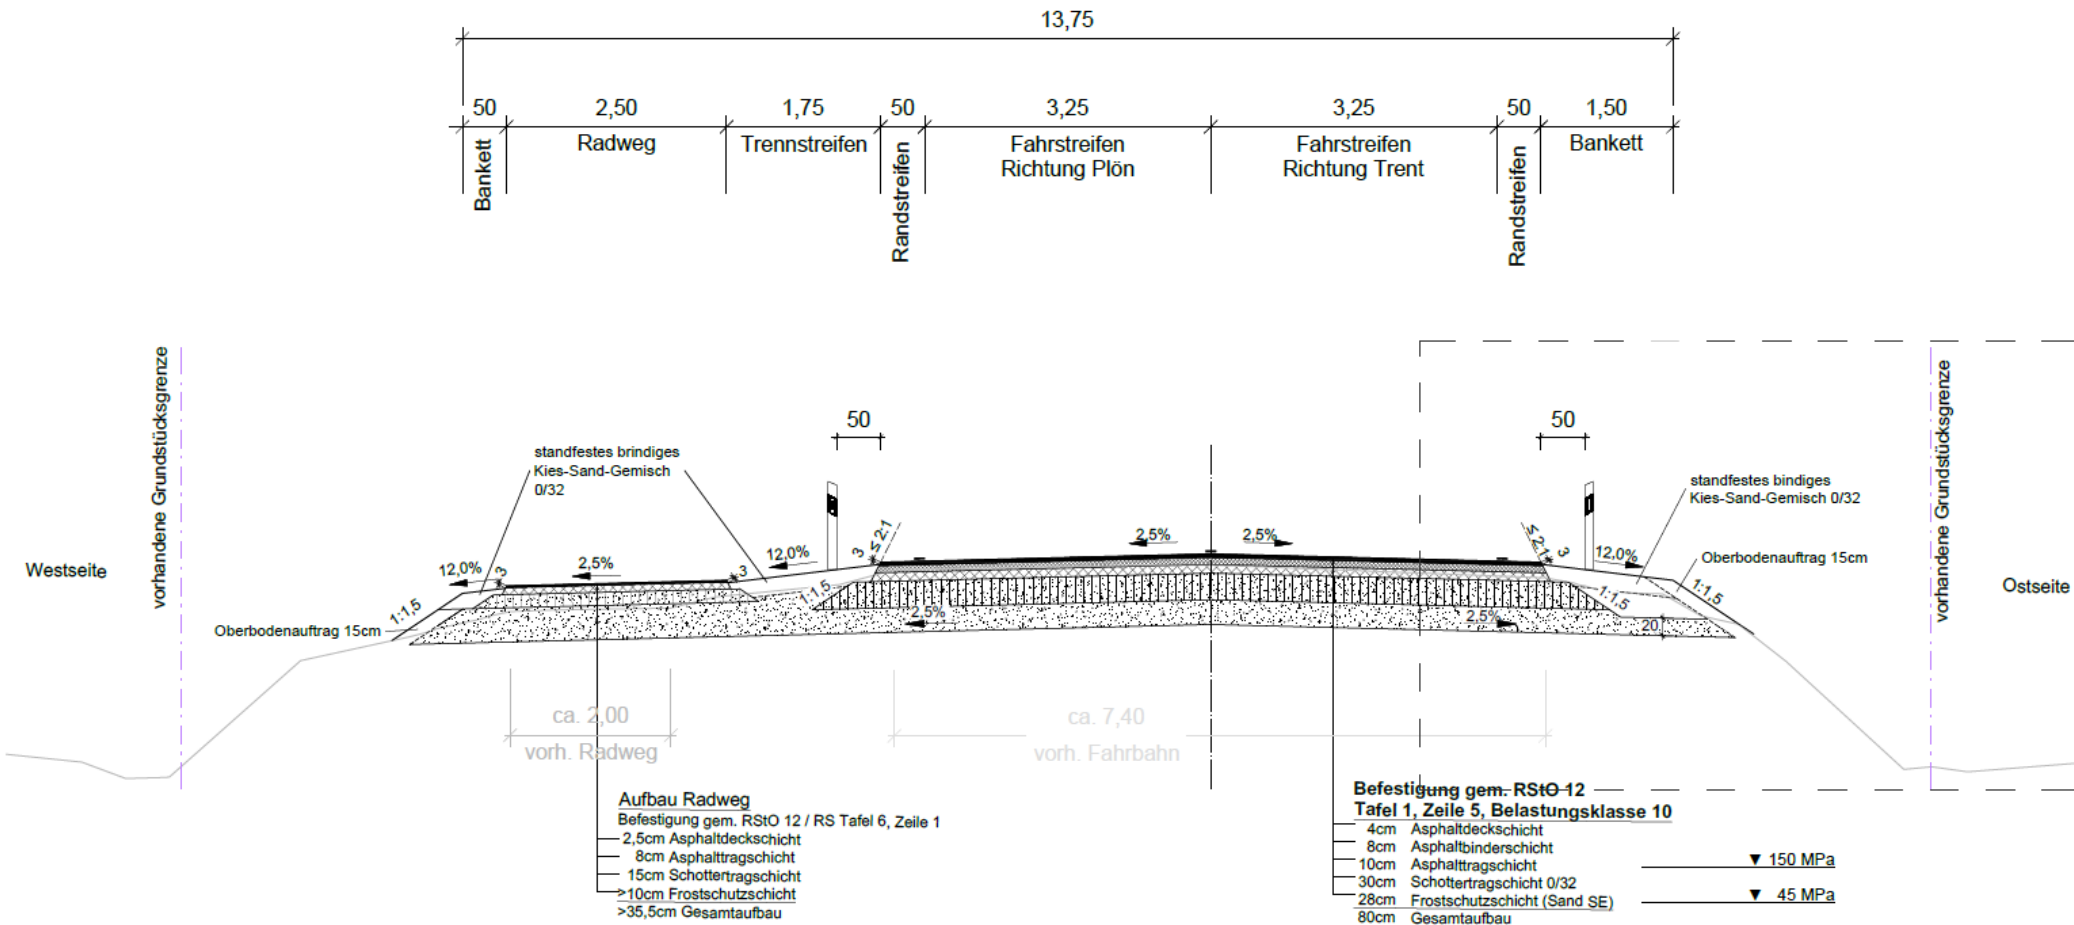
Querschnitt Grundhafte Erneuerung ohne Planumsverbesserung
